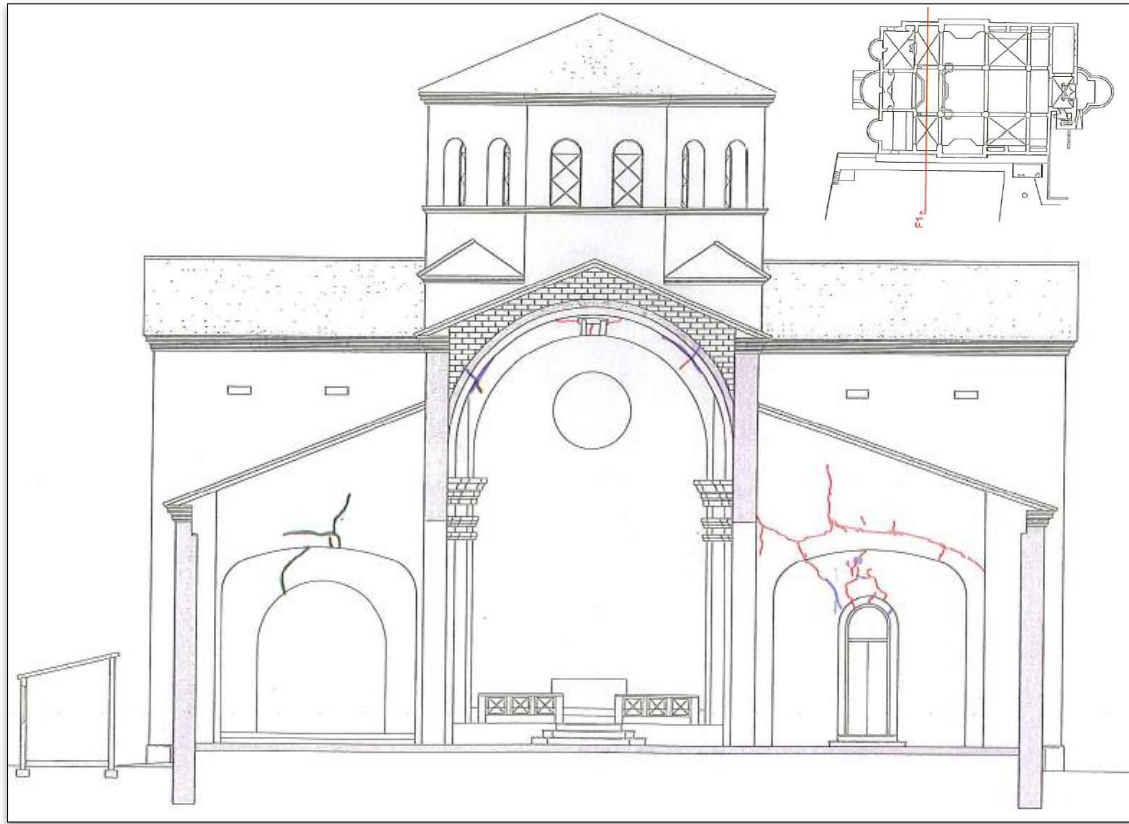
Grietas sección transversal norte 1 (plano PAT. 09)
